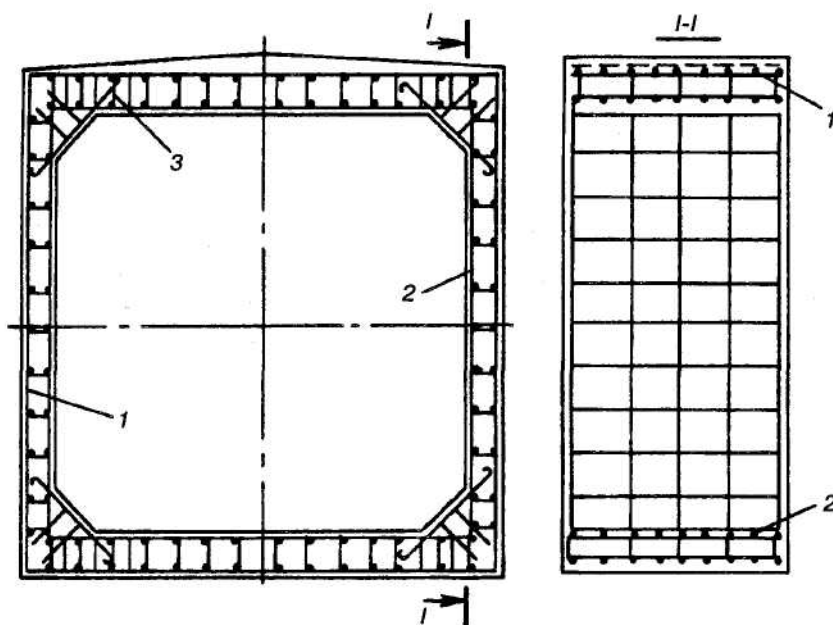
Конструкция железобетонного звена прямоугольной трубы: 1 – внешняя рабочая арматура; 2 – внутренняя рабочая арматура; 3 – продольная распределительная арматура
